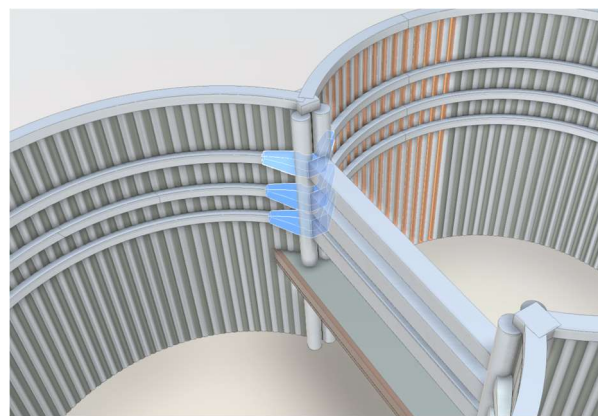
Sección variable en *waler beam*. Zona de intersección entre cilindros
